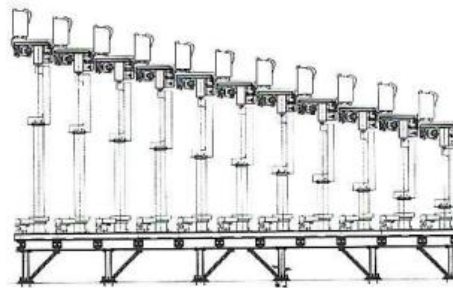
Vue en coupe des gradins du parterre en configuration assise
